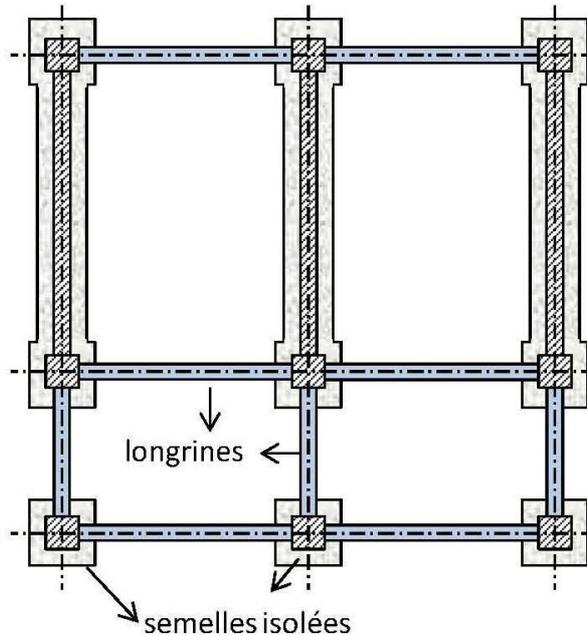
Exemple de liaisonnement des fondations isolées
